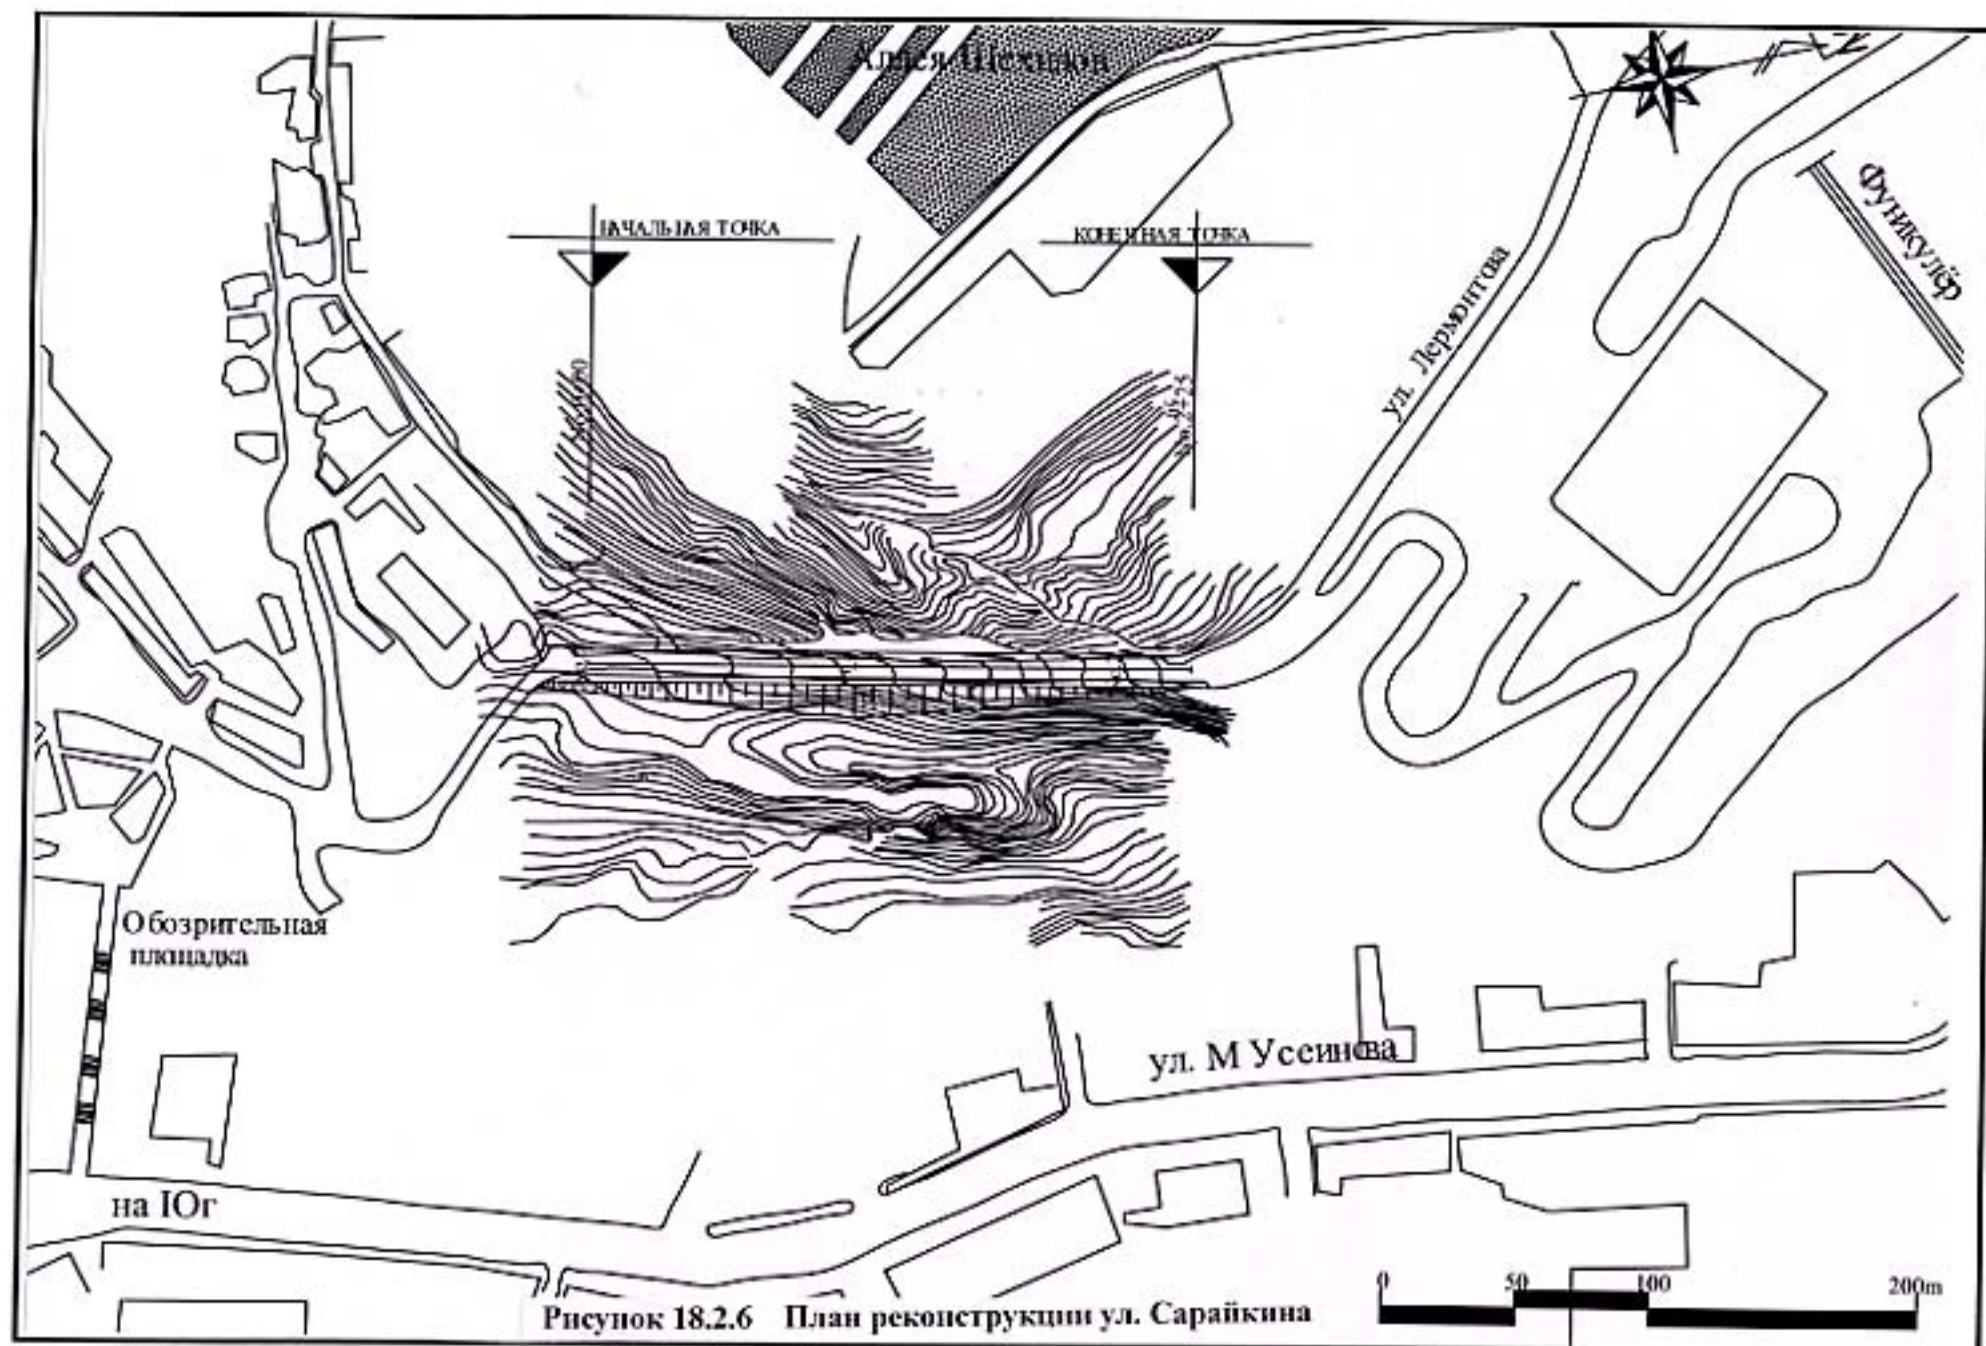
План реконструкции ул. Сарайкина
